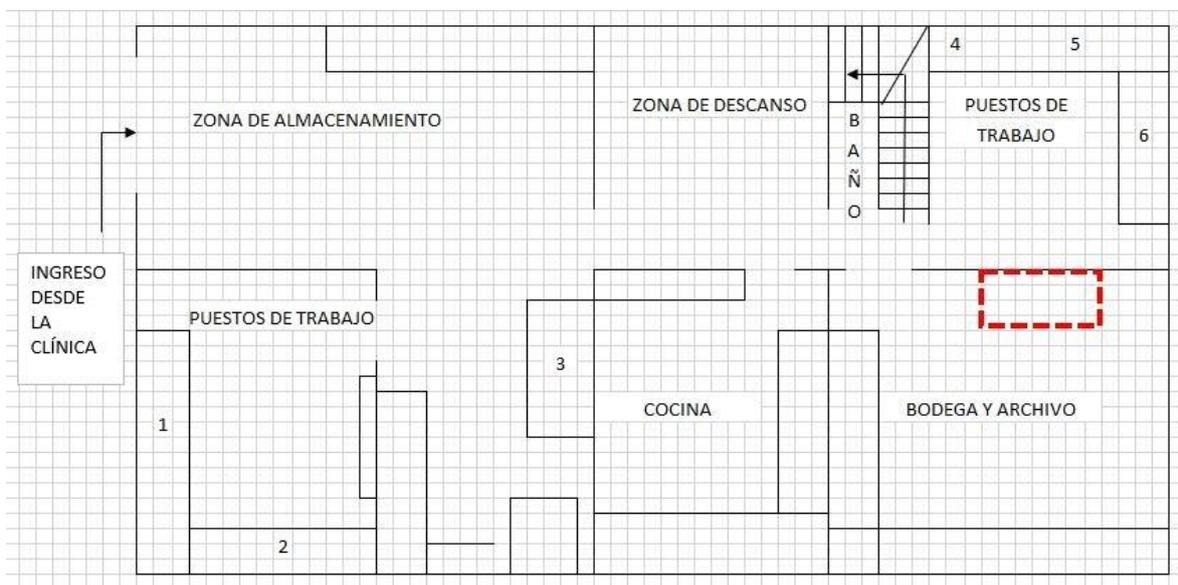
Plano de la primera planta del área de ingeniería biomédica.
